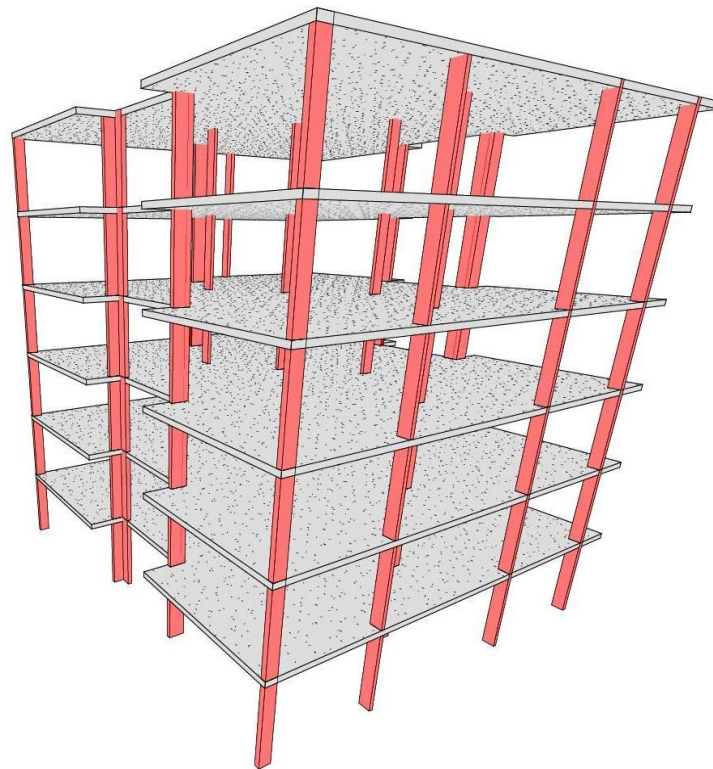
Projeto estrutural, laje lisa protendida - Fonte: Os próprios autores
